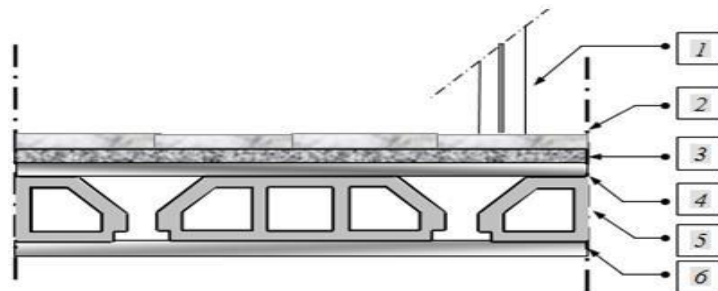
Coupe verticale de plancher courant à corp creux.
